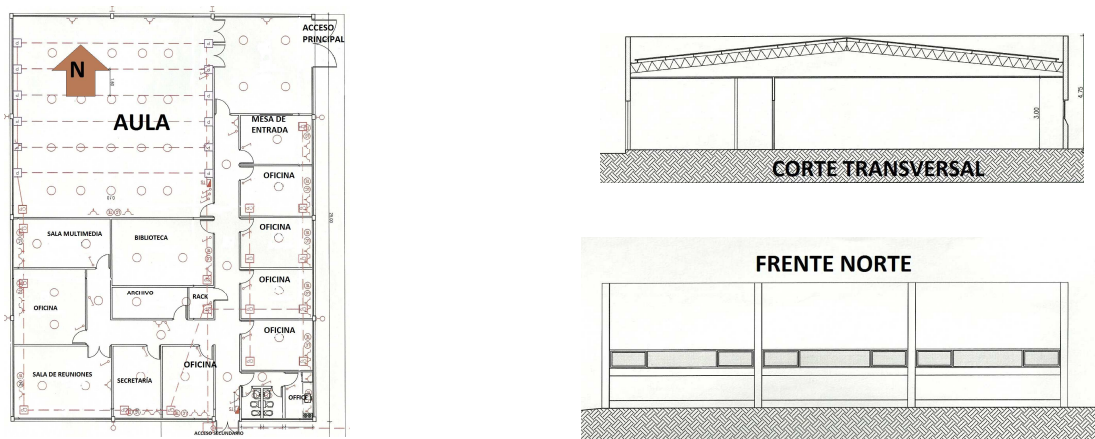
Planta de la EM con la distribución de ambientes que incluye detalles del plano eléctrico, corte transversal y fachada al Norte.
